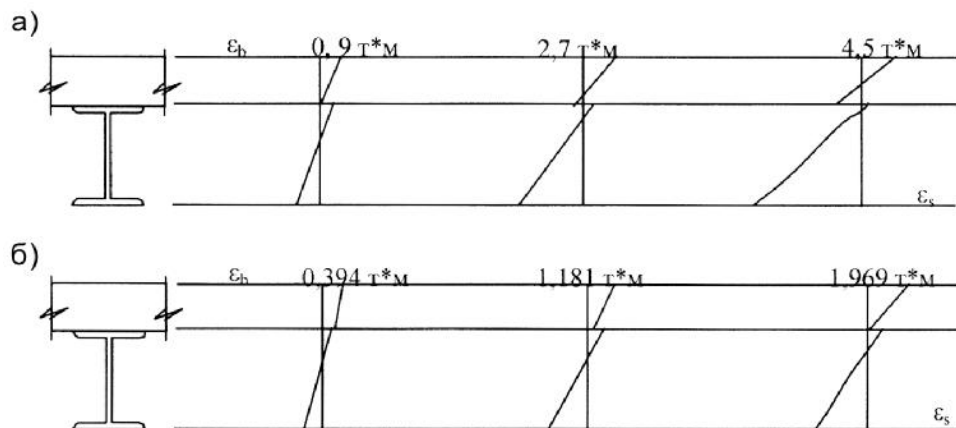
Эпюры развития продольных деформаций по высоте СЖБ перекрытия:
